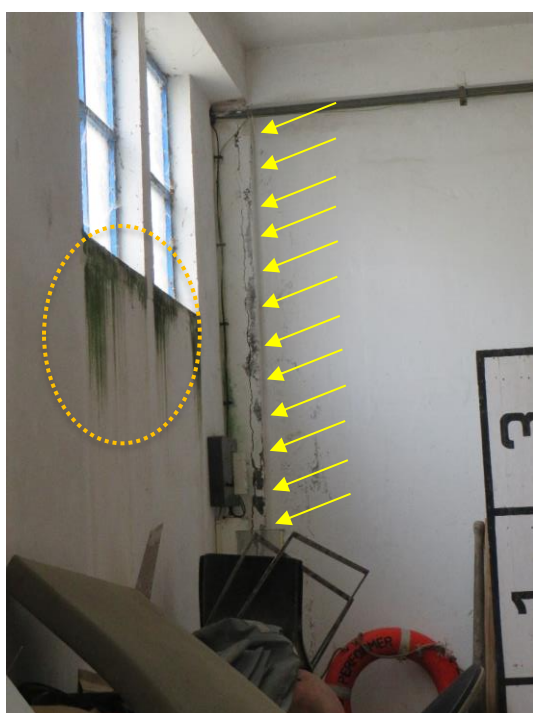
Manchas de humidade no paramento interior da fachada Sul e fissuração em pilar de canto.
